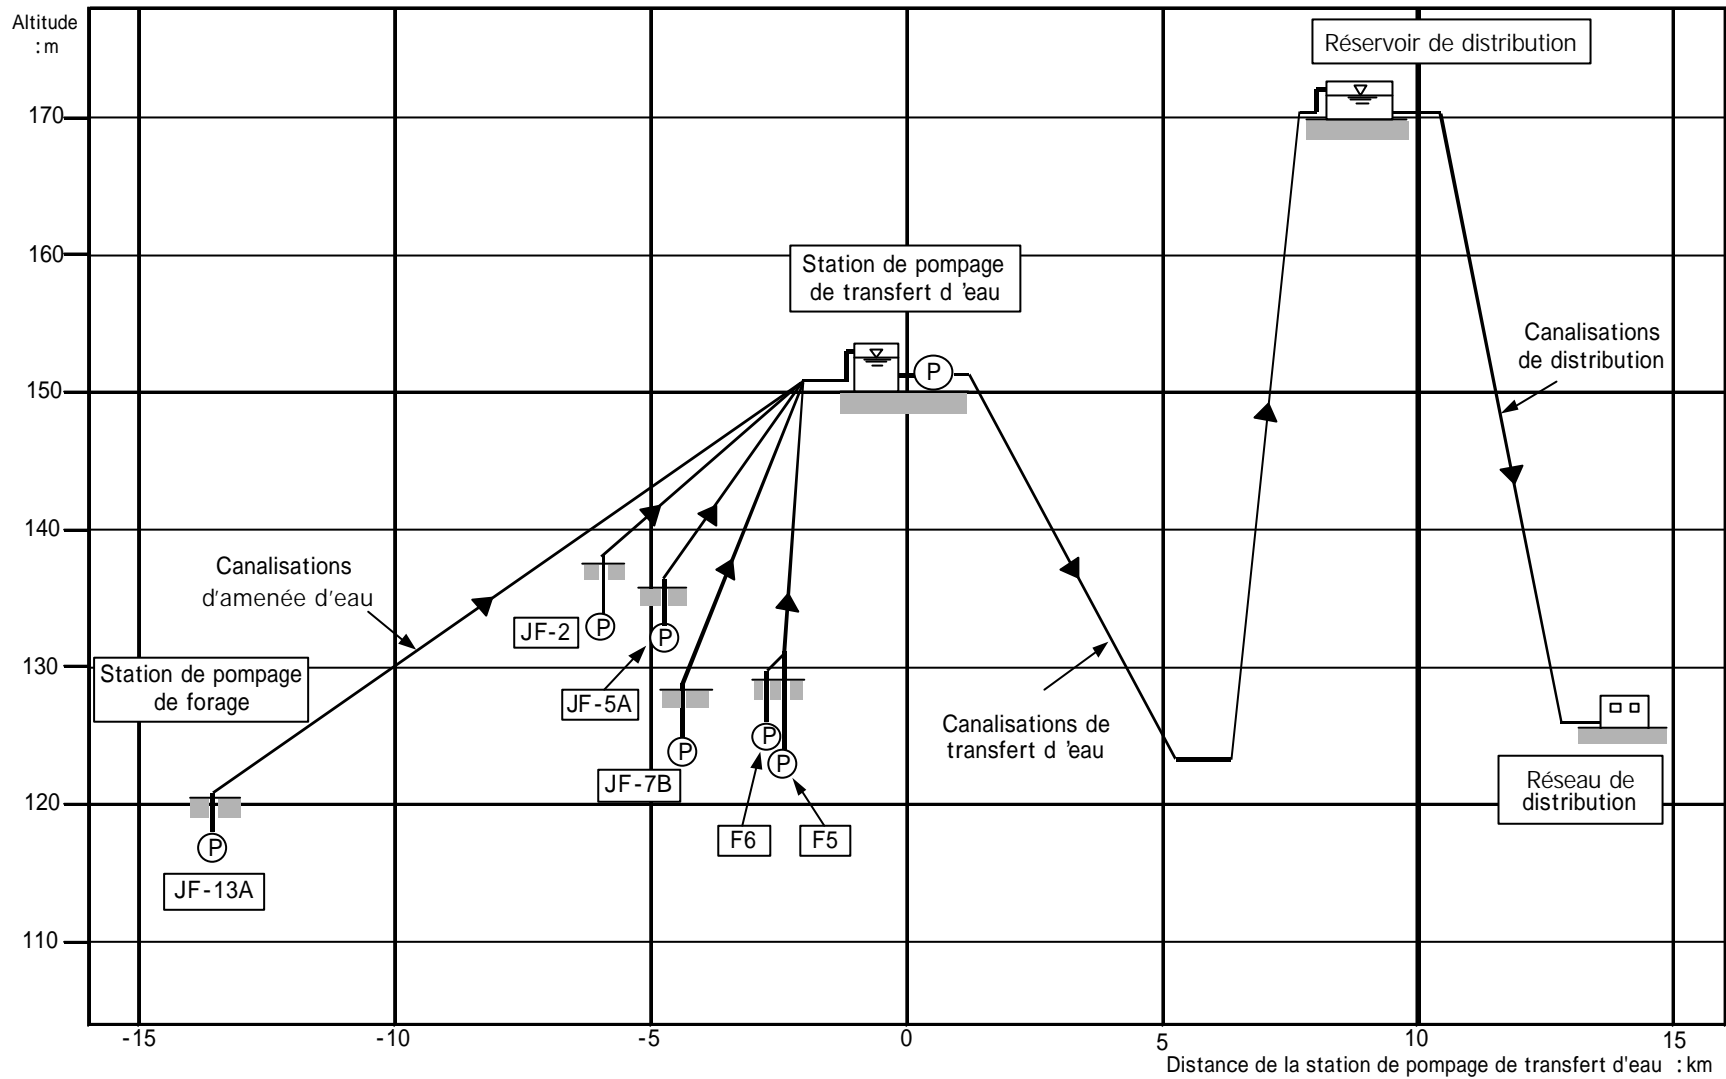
Distances planes et différences de hauteur entre chacune des installations
